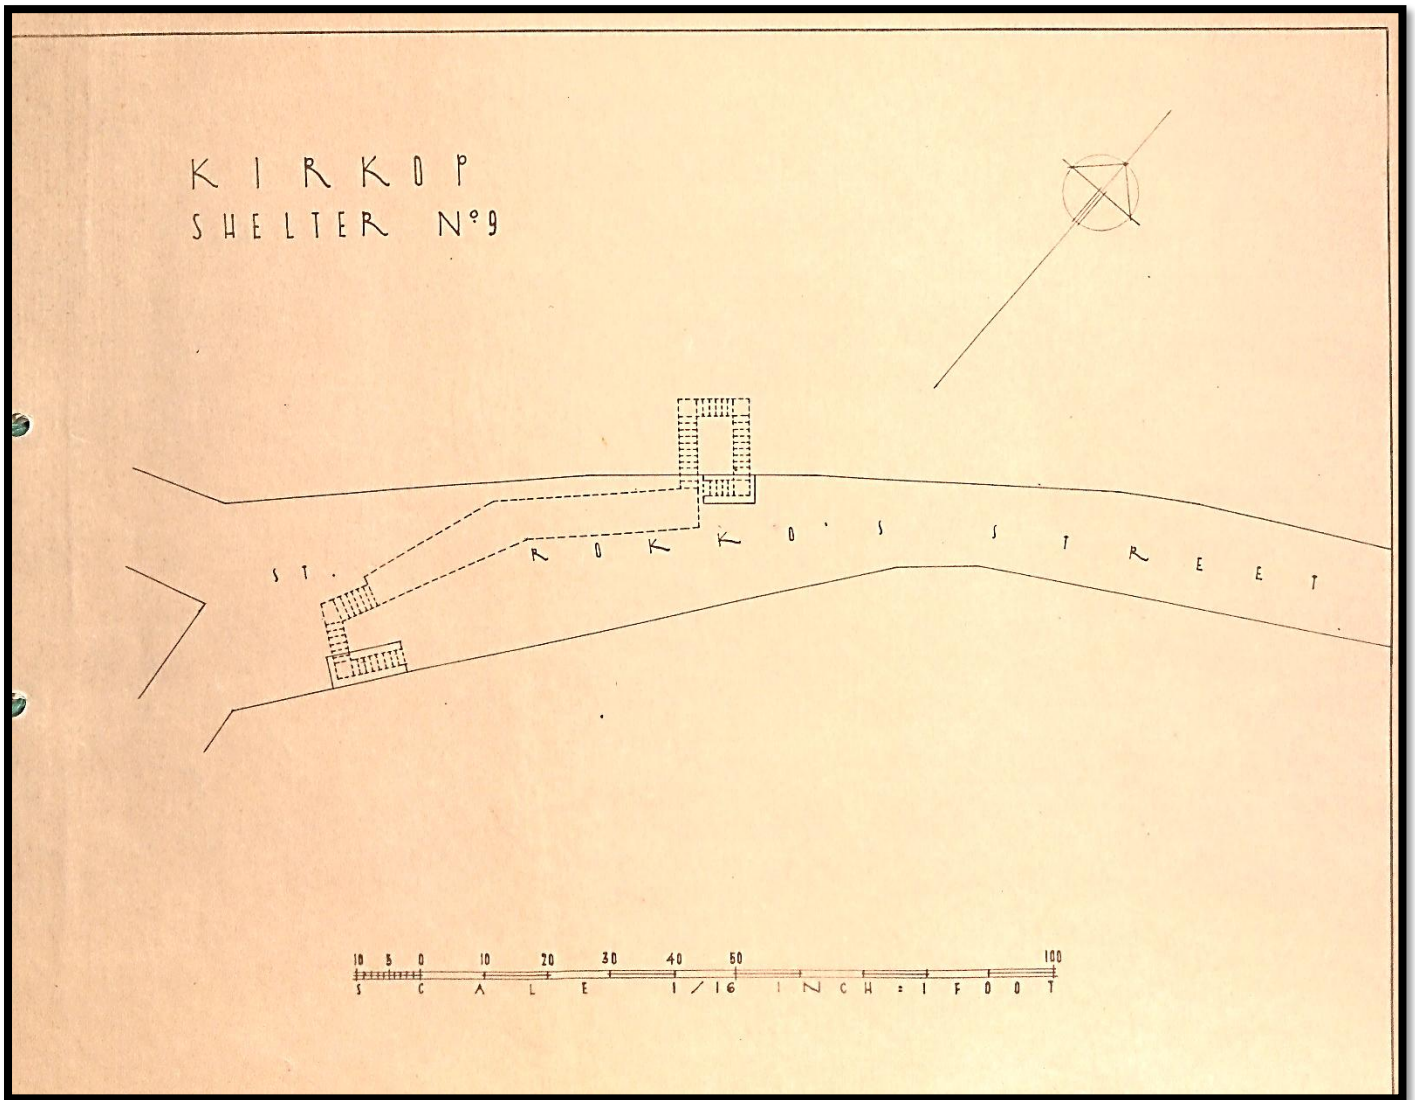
Planta do Abrigo nº9 "St. Rokko Street."
